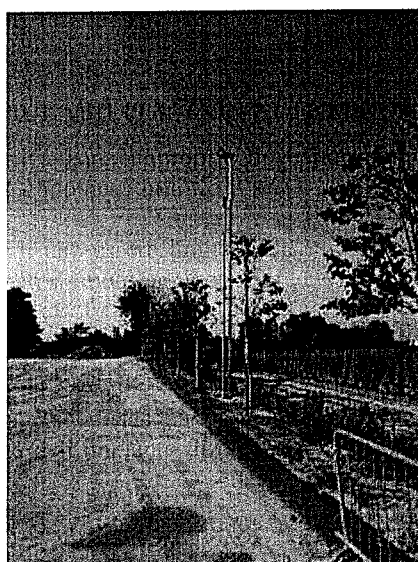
Lato Est dove verrà posizionata la nuova barriera fonoassorbente
